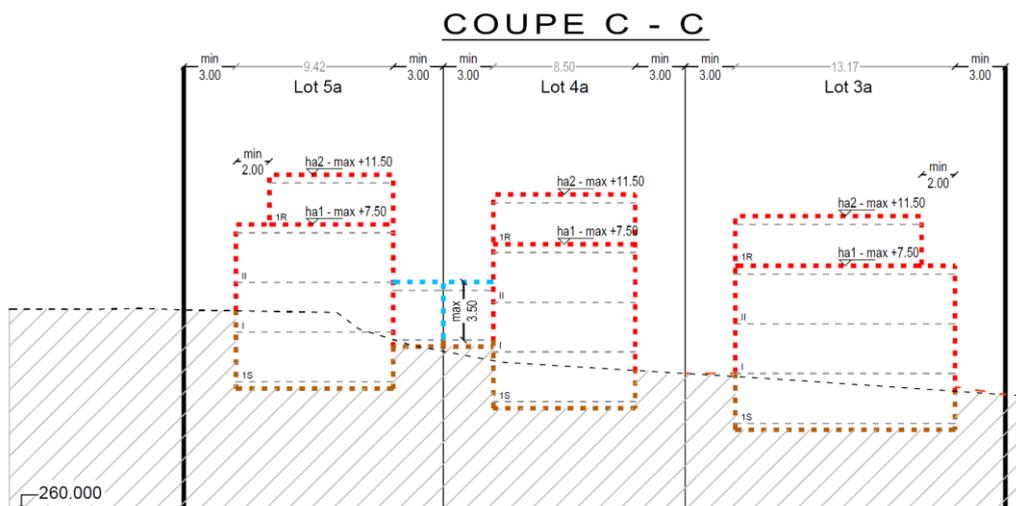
Coupe sur les lots 3a, 4a et 5a (source : BEST).
